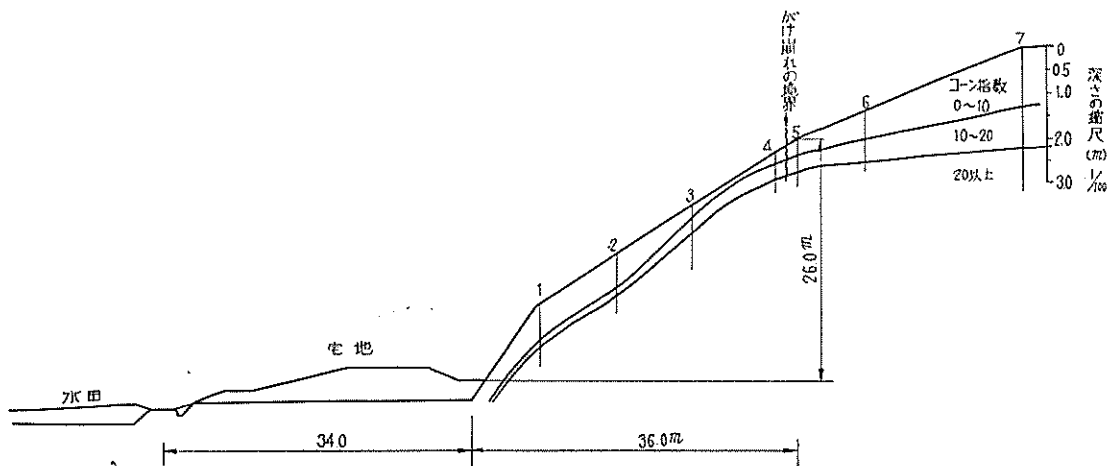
崩壊断面図 (調査地点 No.2 の A-A 断面)
